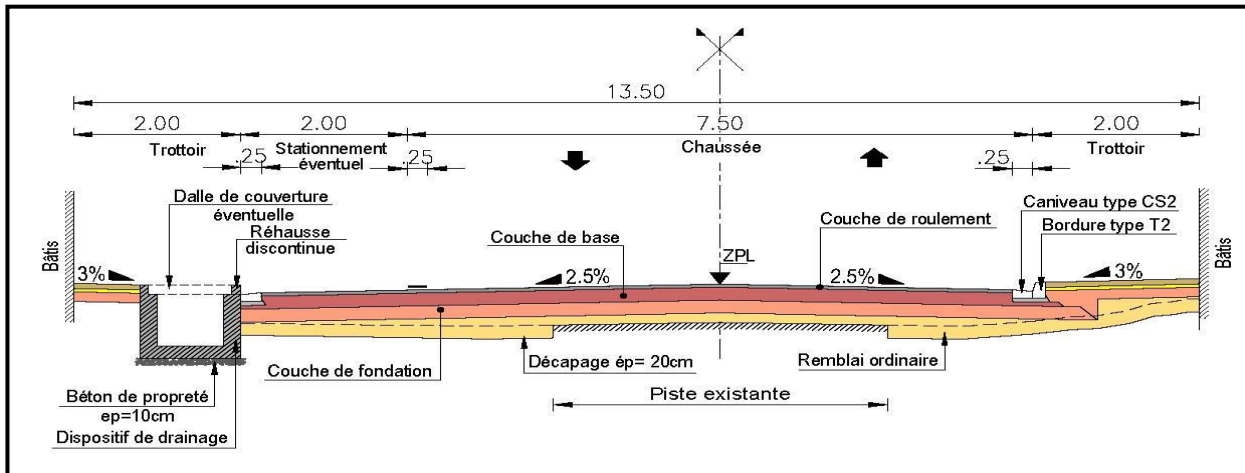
PROFIL EN TRAVERS TYPE 3
